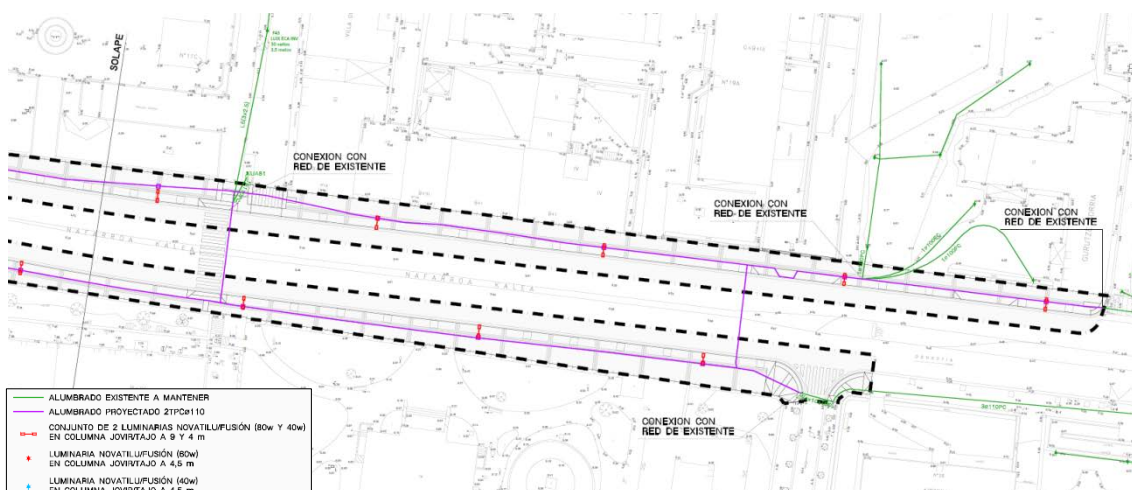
Plano de alumbrado en la zona este de Nafarroa kalea. 2/2
